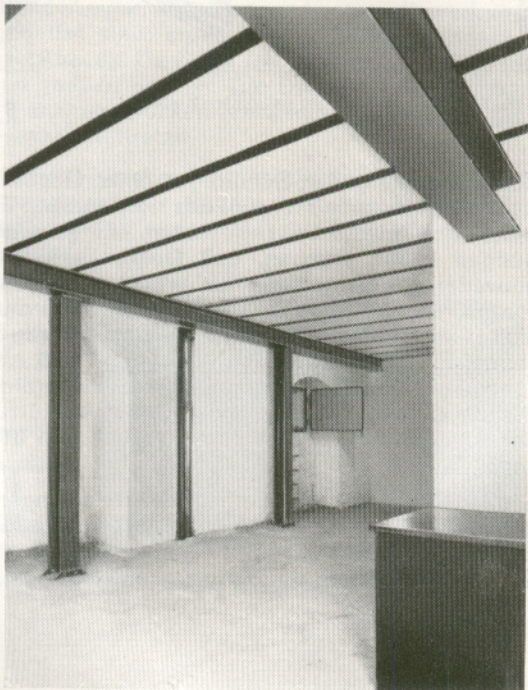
Abstützung einer ebenen Kellerdecke mit Stahlträgern und Betonplatten.
